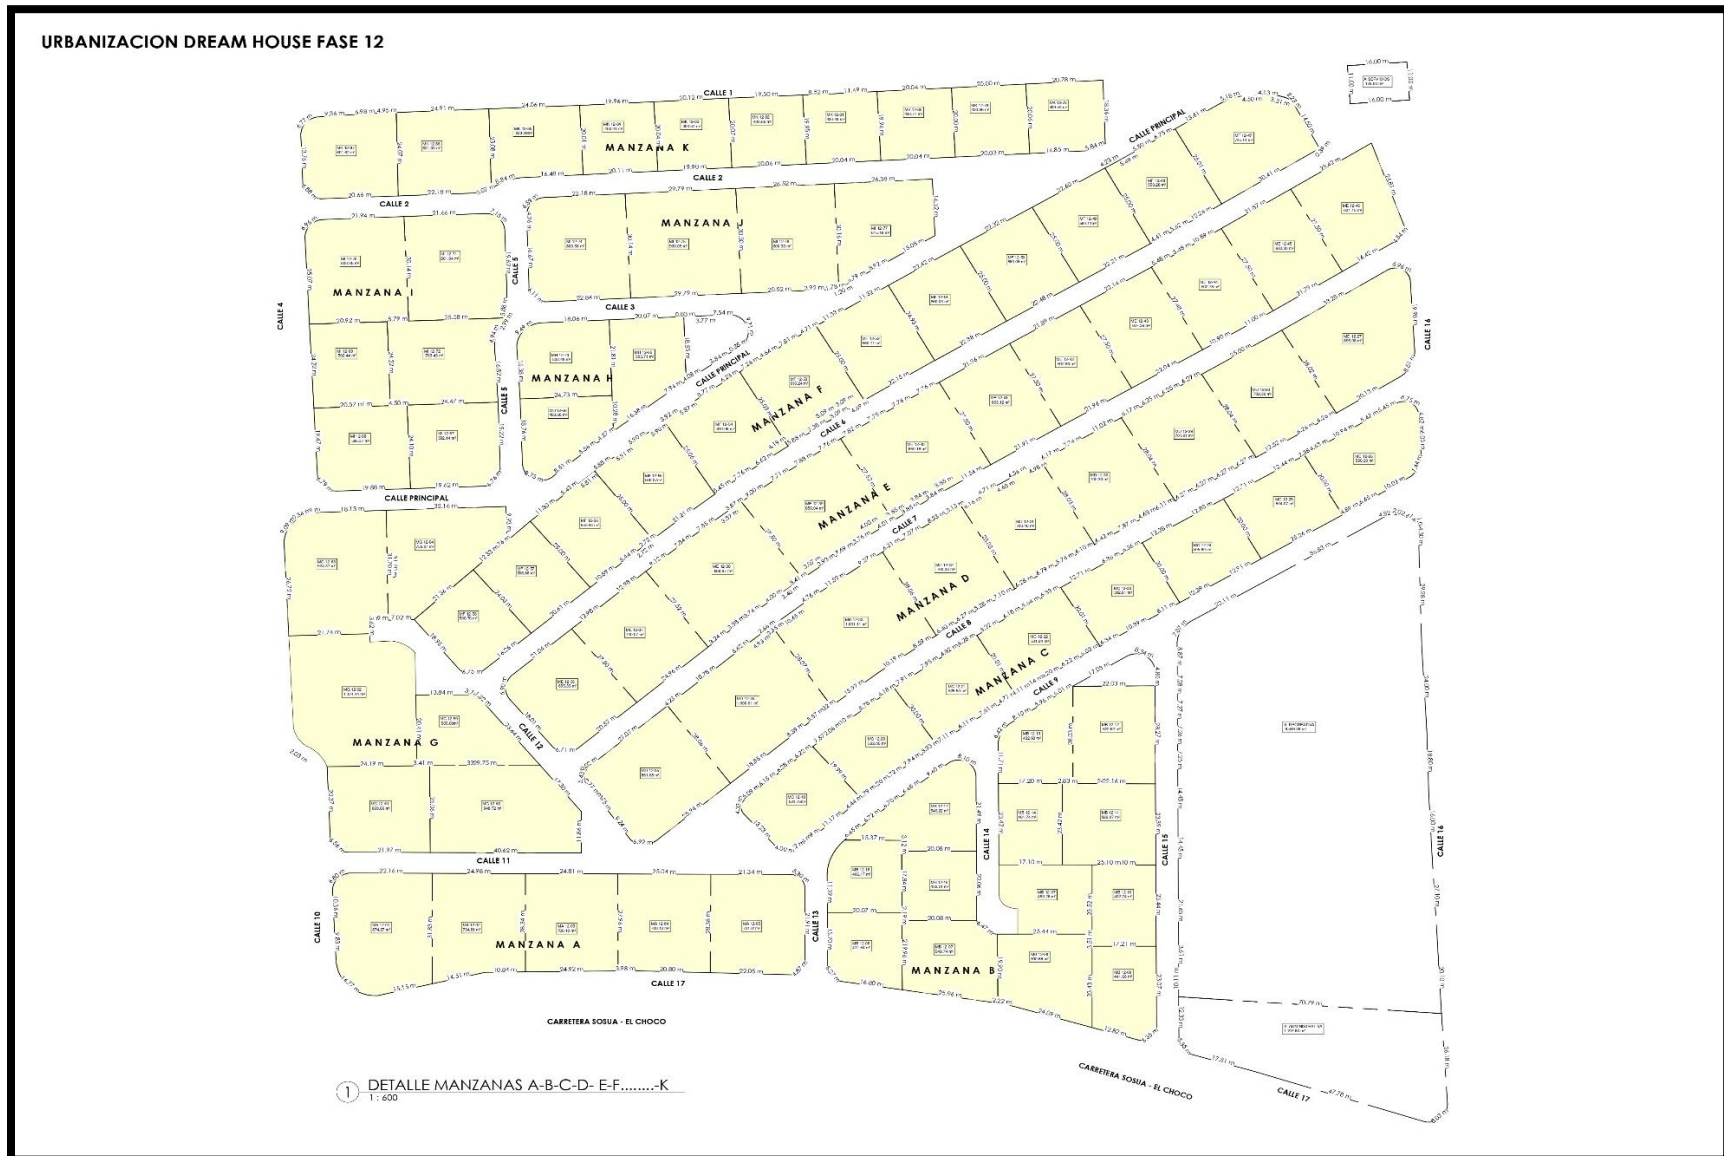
Plano de detalle de distribución de las manzanas del residencial.
